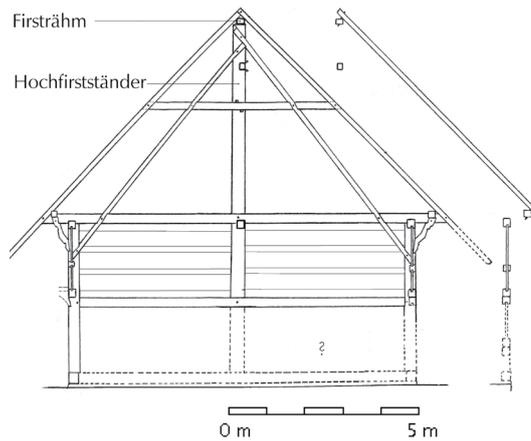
Hochfirstständergerüst mit ursprünglich vier hintereinander aufgestellten Hochfirstständern. Dachsberg-Wittenschwand (Lkr. Waldshut), Haus Nr. 2, 1580 (d).
